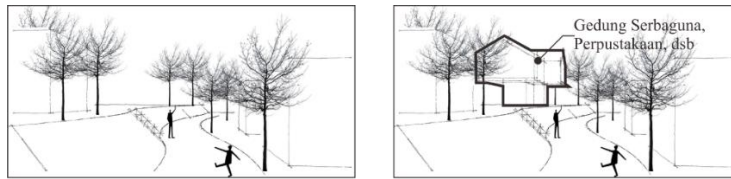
Hirarki Ruang Eksterior Pada Ruang Kelas
